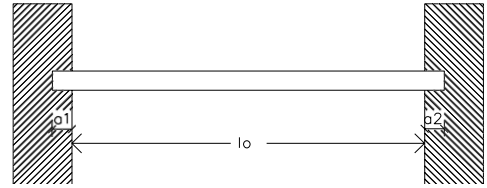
Vigas con apoyo sin restricciones al giro.
